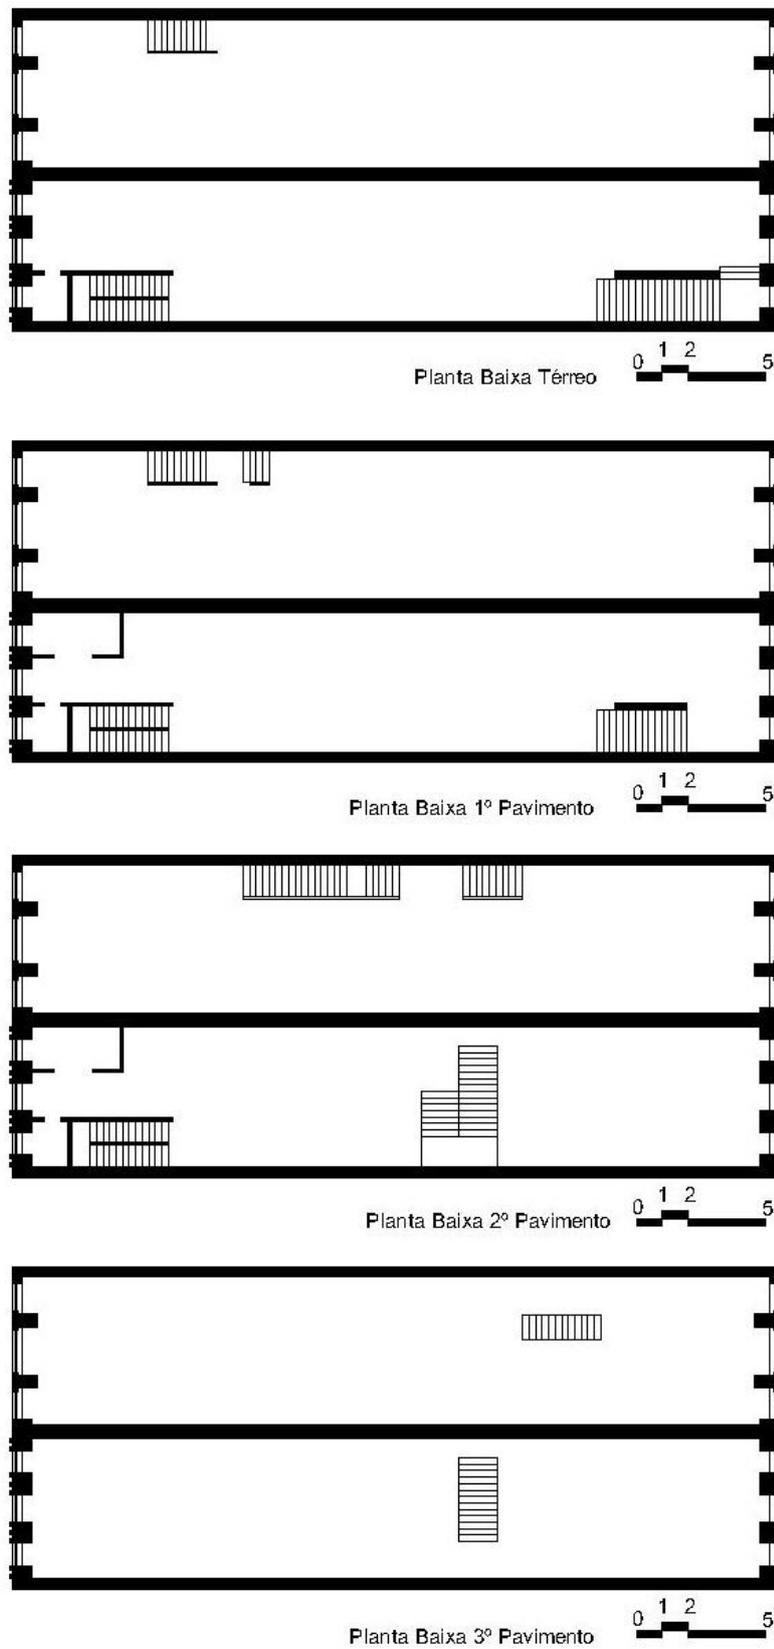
Planta dos sobrados antes da reforma executada por Jerônimo e Pontual arquitetos para implantação do BANORTE. Fonte: a autora.
